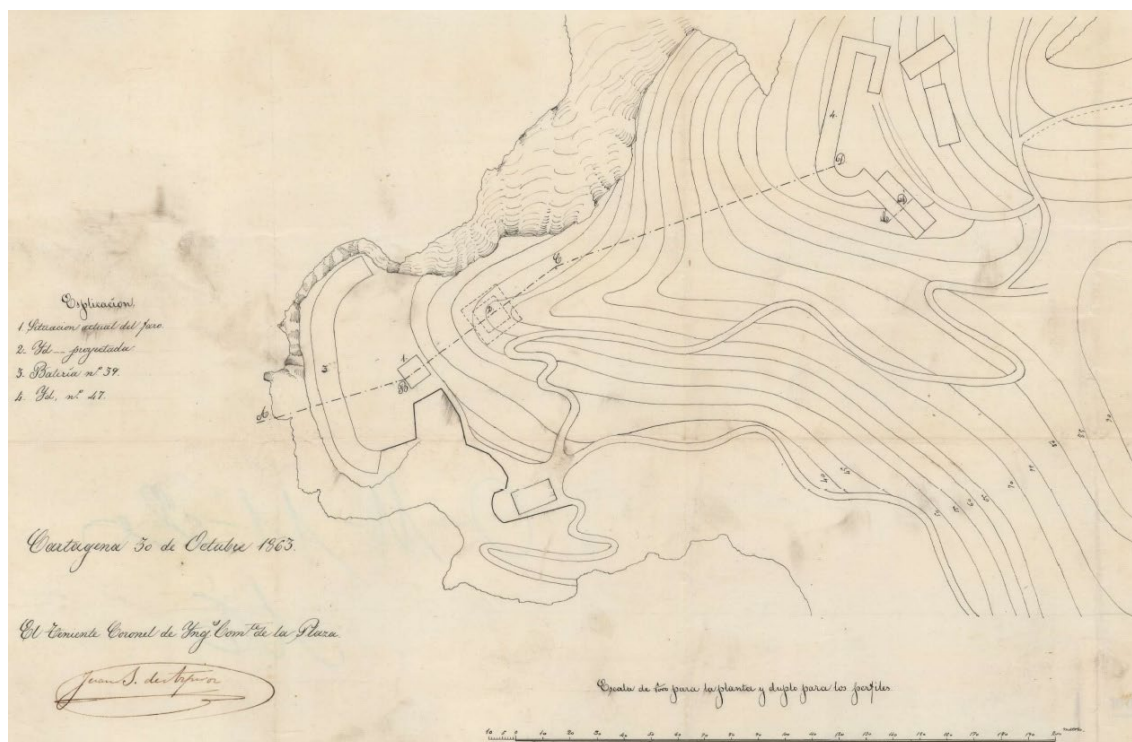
Plano de la situación proyectada del faro de la Podadera. Fuente: Plano y perfil del terreno comprendido entre la batería n.º 39 y la 47 para indicar la situación proyectada del faro de la Podadera. Juan B. Aziproz, 1863 (AGMM: MU-2/16-BVD)
